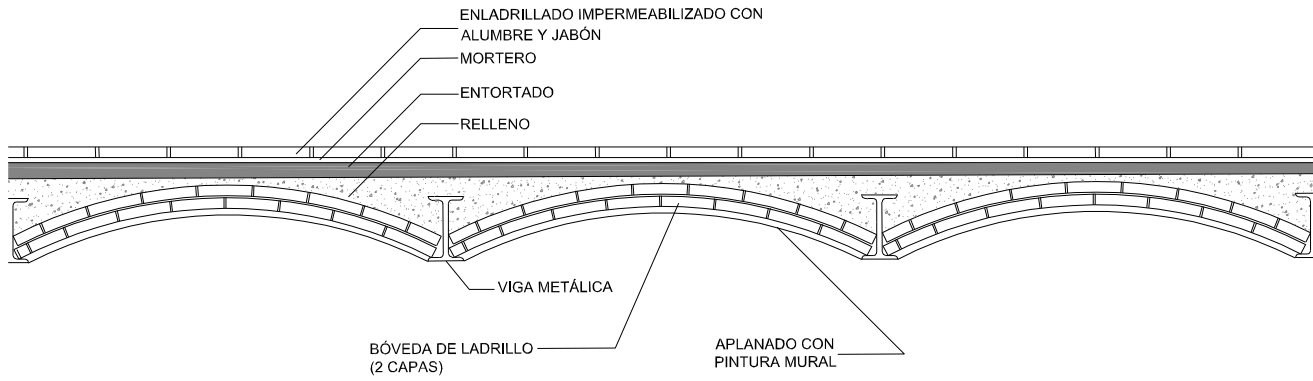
Detalle constructivo de bóveda catalana doble hilada.
